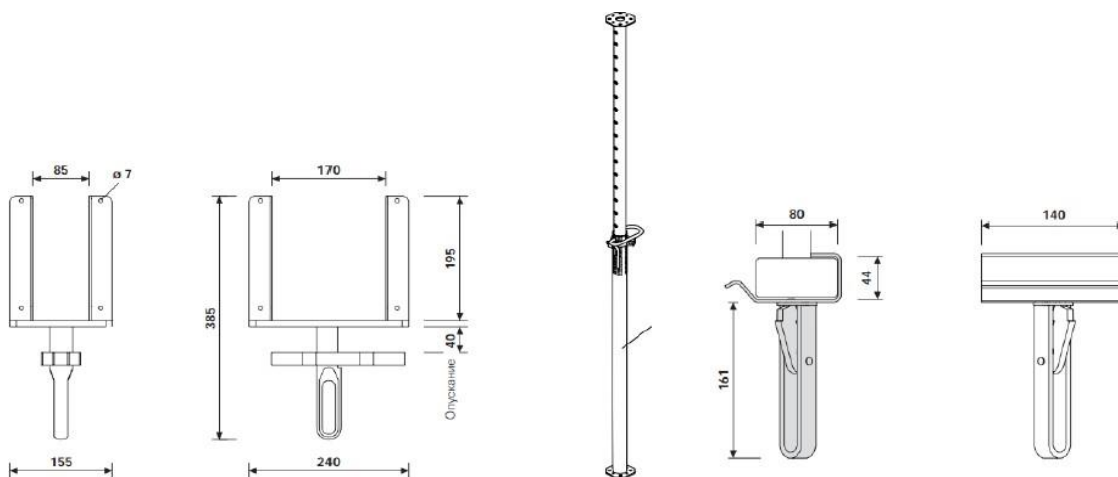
Стойки типу РЕР, падаюча головка та головка захват [14]
